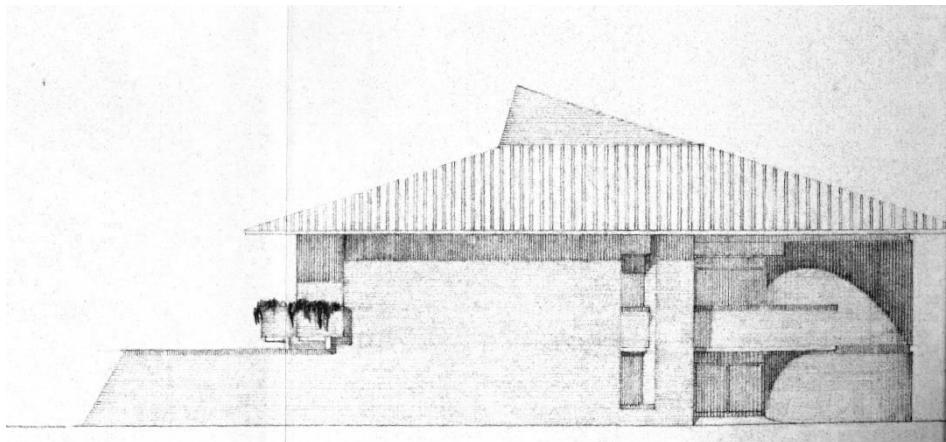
Alzado del Edificio de Viviendas de la calle Eza. 1965-1967
